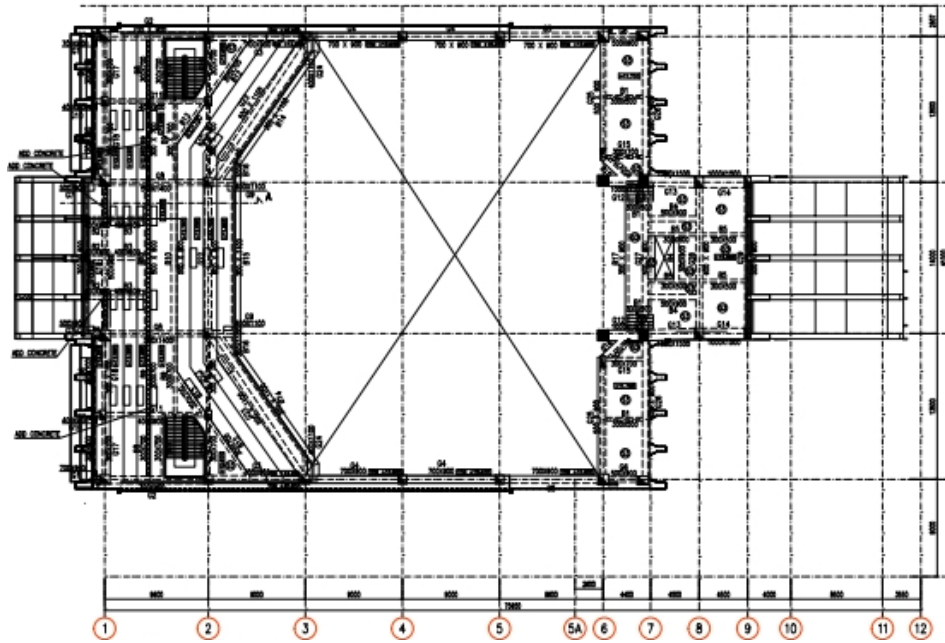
Pekerjaan Penulangan Balok Lantai 4 Gereja SPMBG
